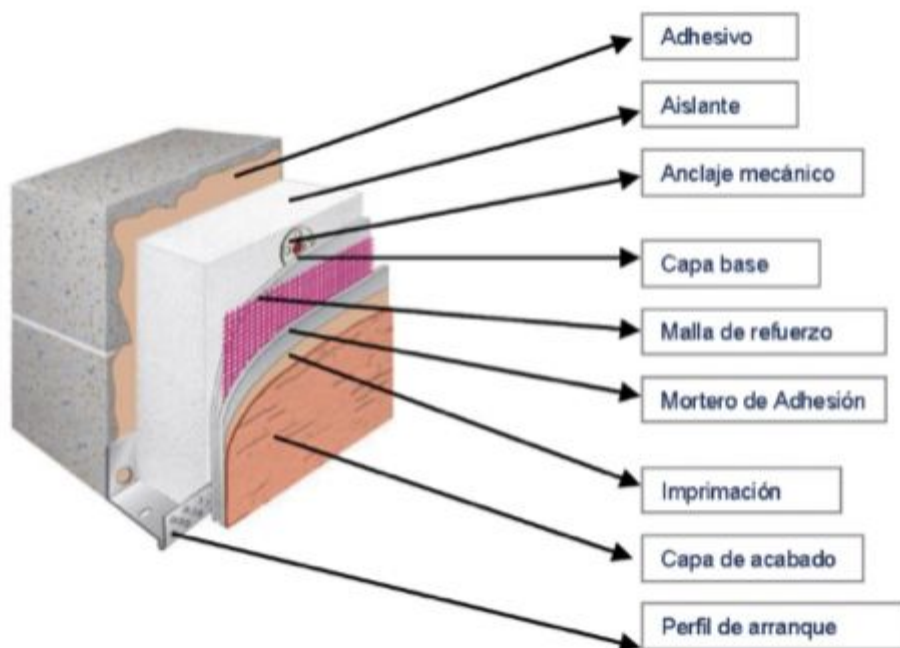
Sección fijación mecánica anclajes mecánico y mortero (Fuente: Murart)
